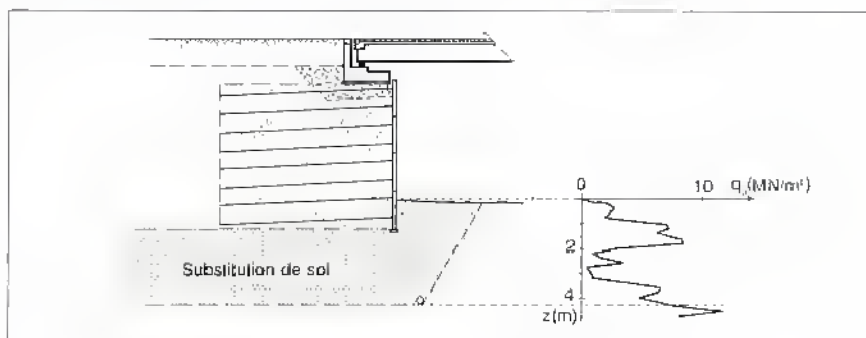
Substitution de terrain sous les culées du pont de Kortrijk.
